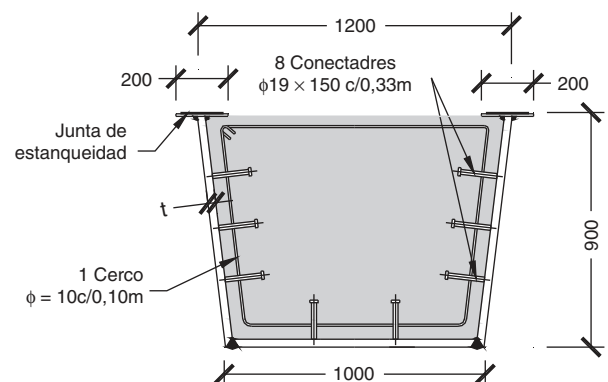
Sección transversal del cajón metálico inferior relleno de hormigón.
